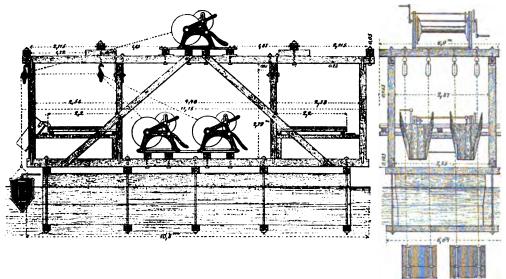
Betonirungs-Gerüst. Seitenansicht.
